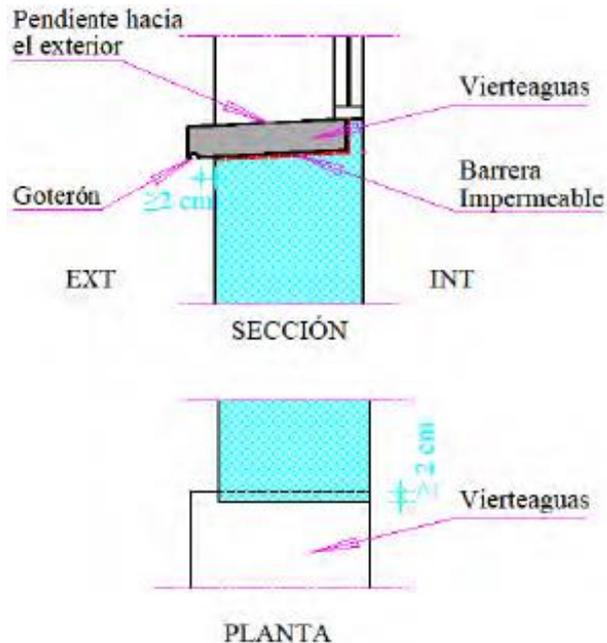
Encuentro de la fachada con la carpintería. Fuente CTE
